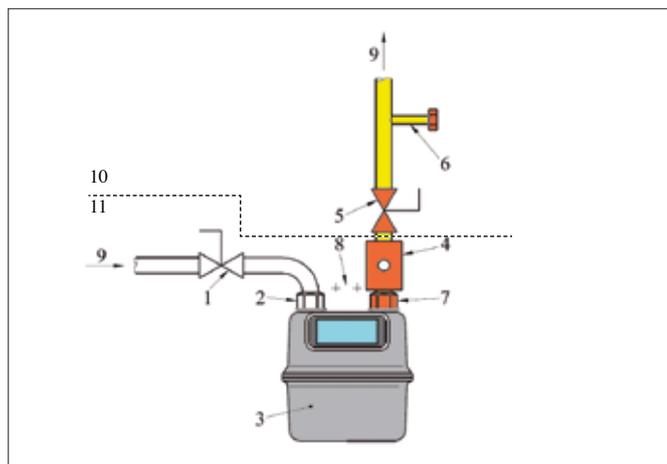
Schema gruppo di misura e collegamento all'impianto gas allacciato ad una rete di distribuzione
